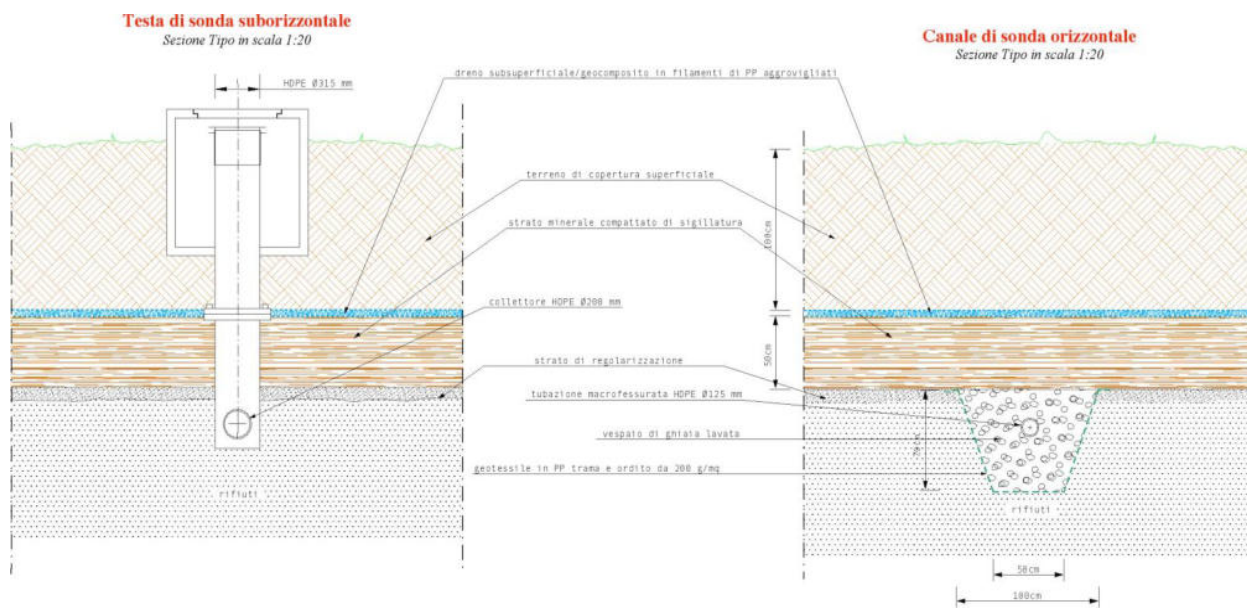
Sezione schematica dei rami di sonde orizzontali e testa pozzo, dal PdA (Maggio 2004)
